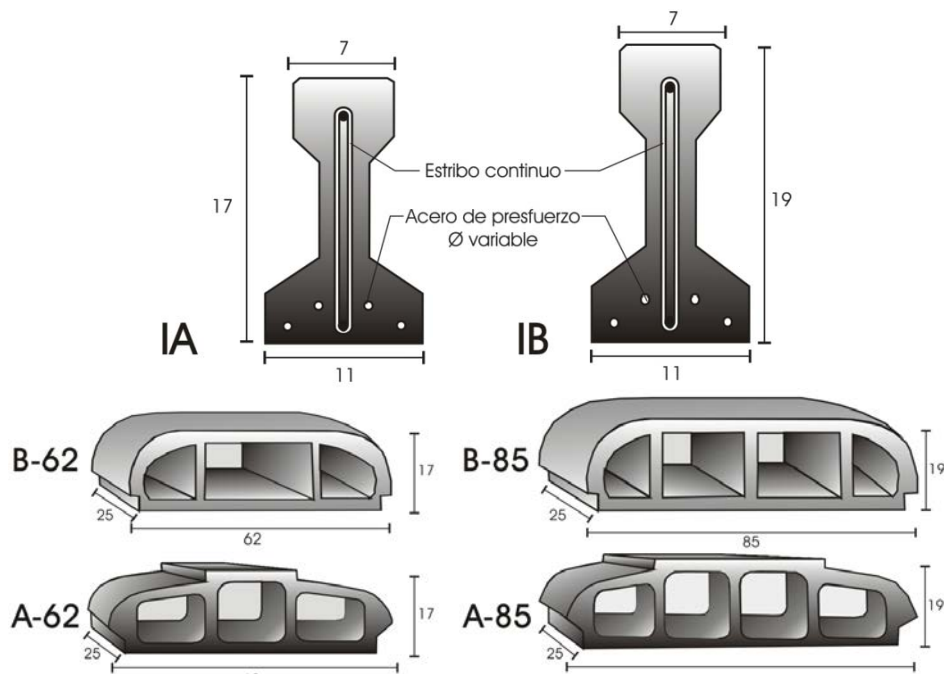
Dimensiones de viguetas y bovedillas
